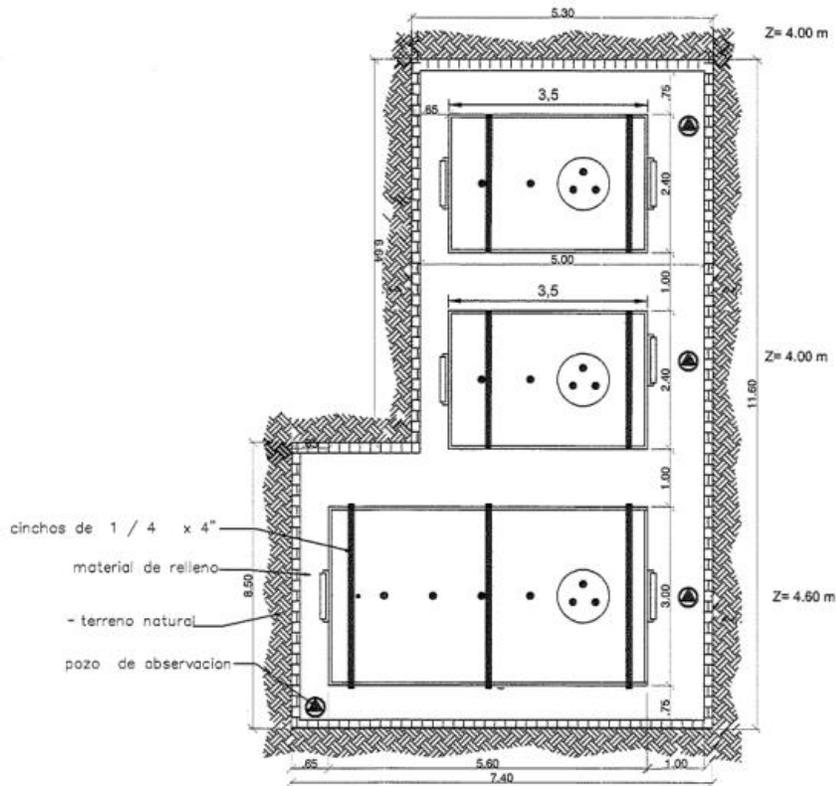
Planta arquitectónica y detalles de Tanques de Almacenamiento
